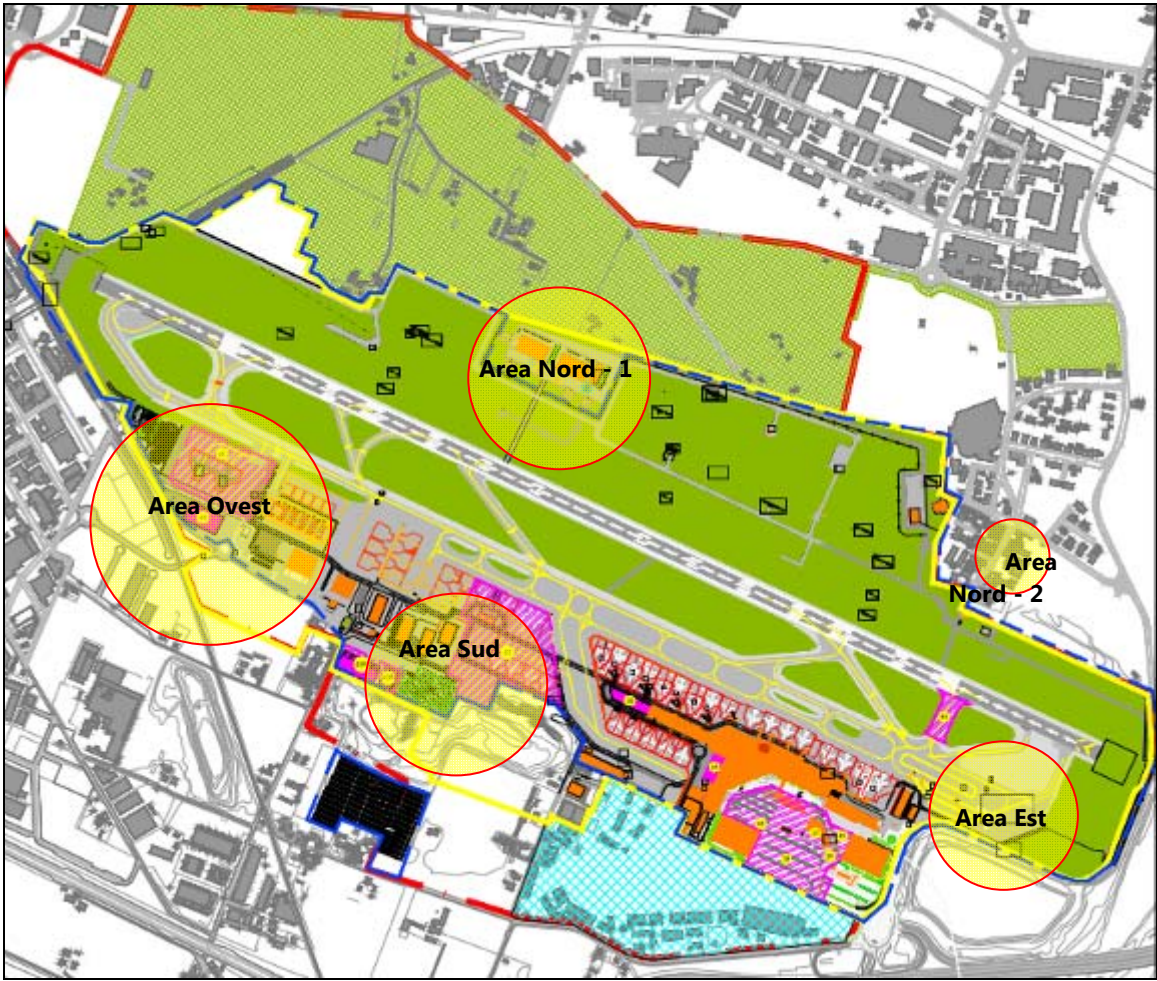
Planimetria con lo stato di progetto al 2030 con localizzazione degli interventi
